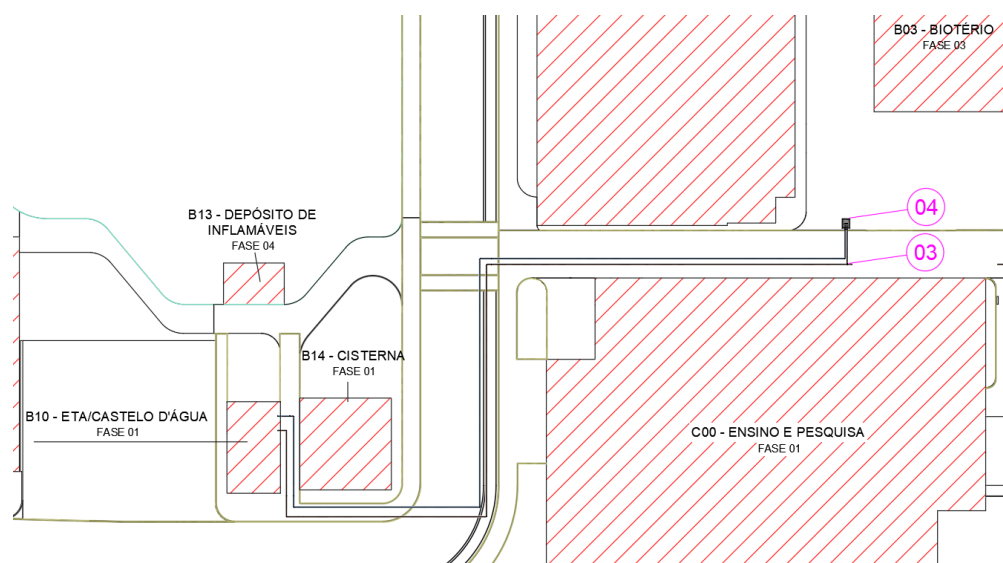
Planta trecho (Castelo d'água / Bloco B03)
